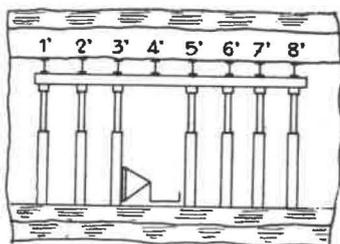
Coupe C-C de la figure 2 montrant qu'il suffit d'enlever 2 ou 4 étançons hydrauliques pour permettre le ripage du rabot et du convoyeur.
